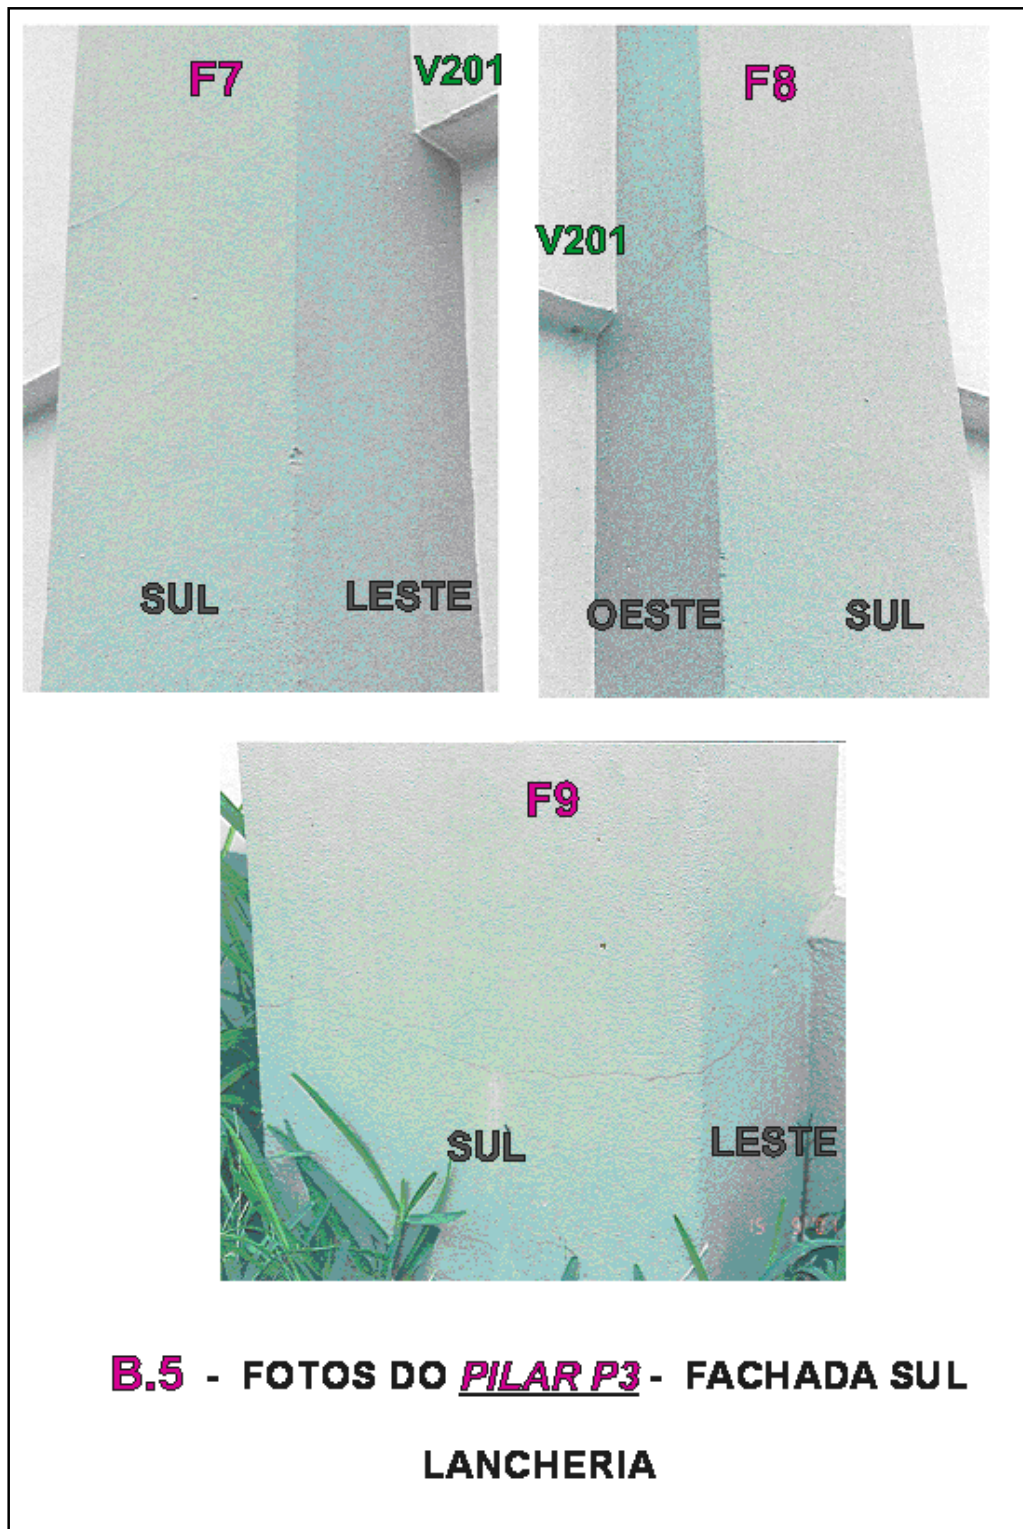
Fotos de fissuras manifestando-se no pilar P3, fachada sul da lancheria (ISAIA, 2001, p. 48)
